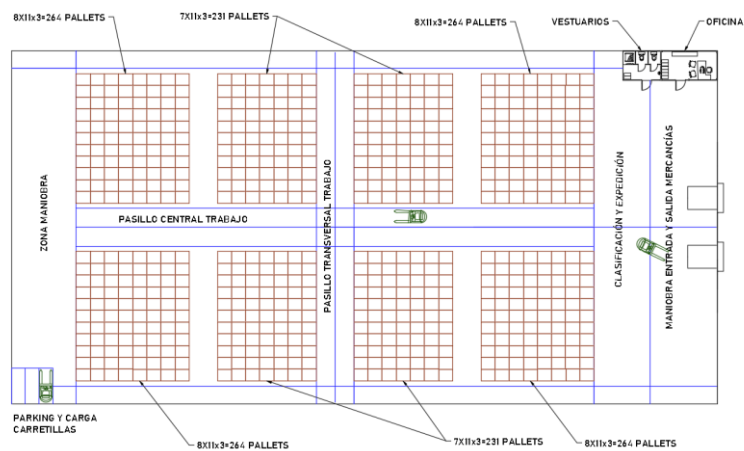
Configuración del layout de distribución de planta. Documento III-Planos
